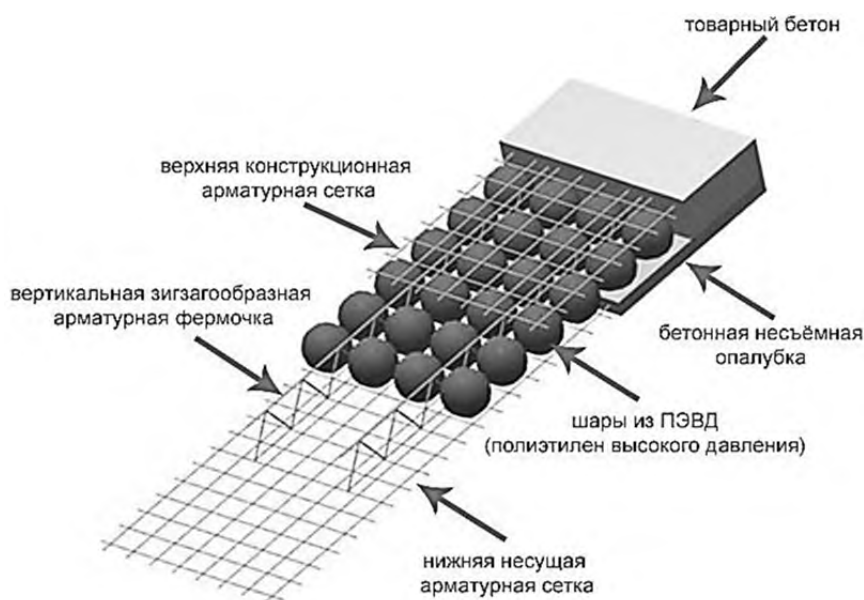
Перекрытие «BubbleDeck» Йоргена Брёнинга
